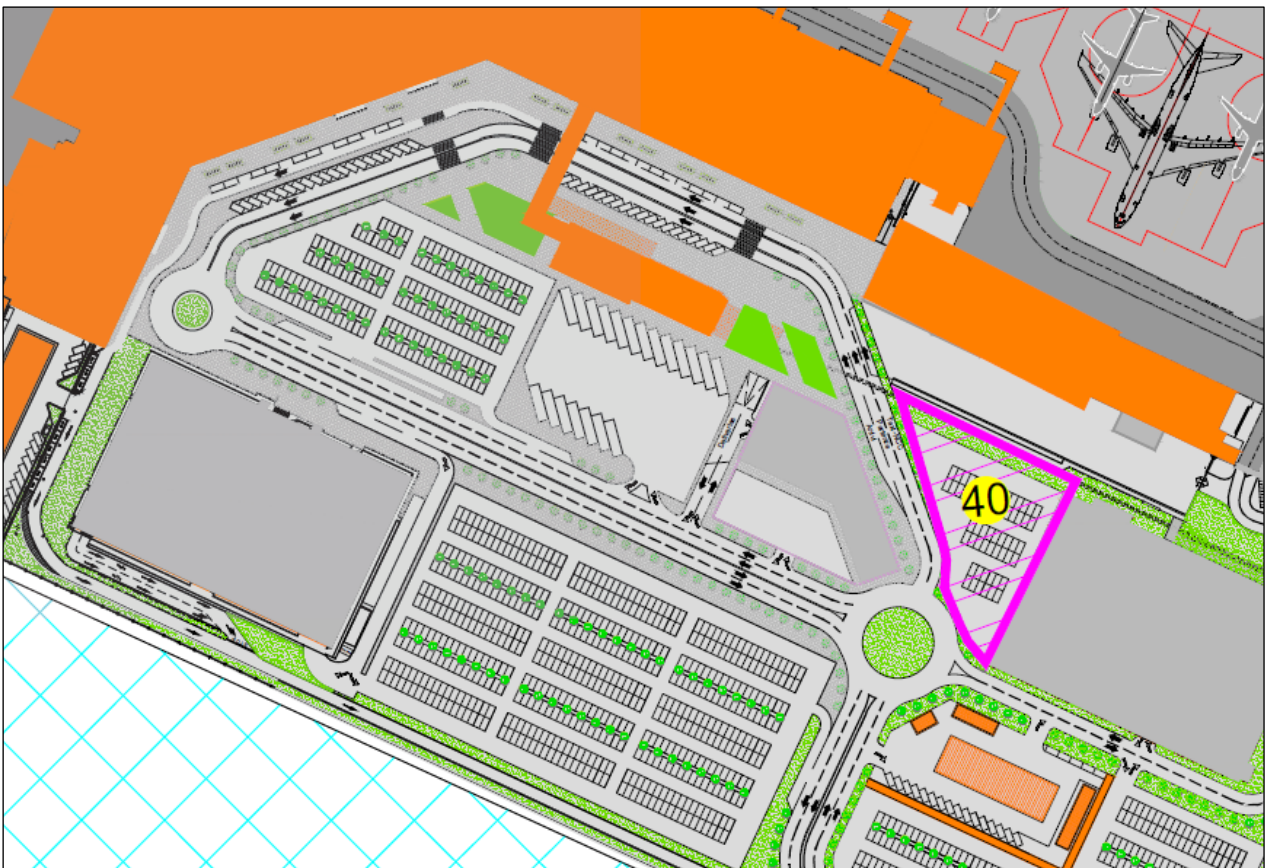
Estratto Master Plan – Nuovo Parcheggio Fronte Terminal Arrivi
